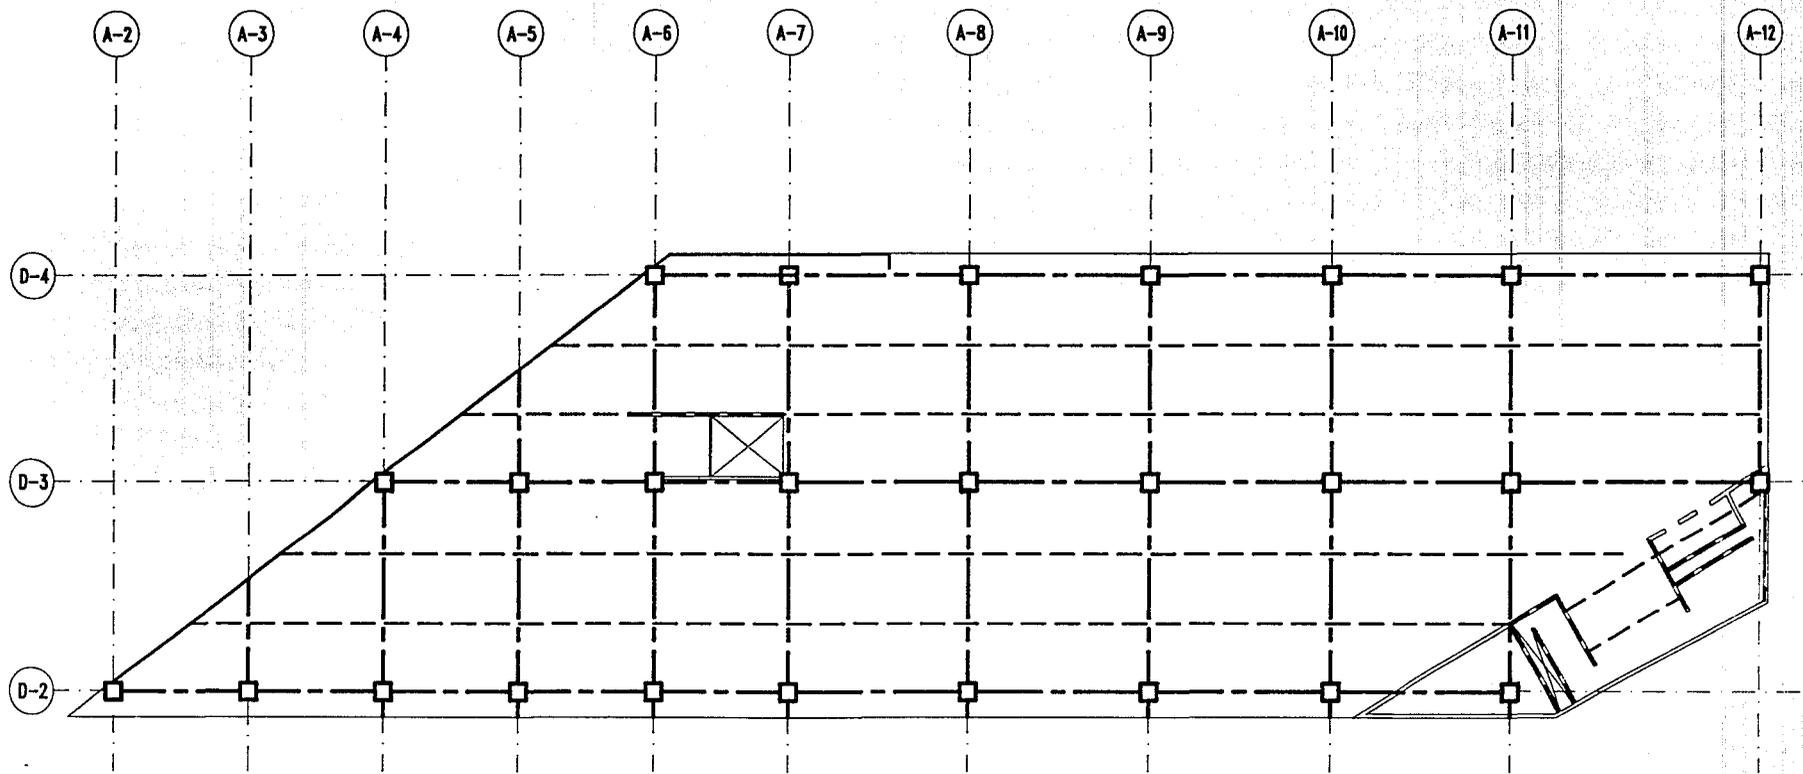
LOCALIZACION DE MARCOS EN PLANTA BAJA. CUERPO B.
